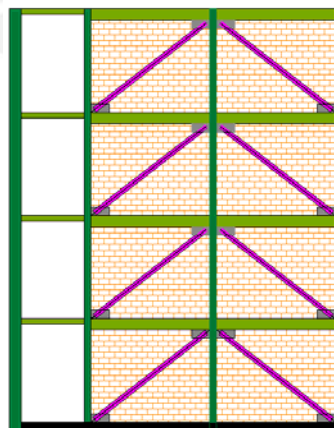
Vista de reforzamiento de muros con arriostres metálicos a cada lado.
